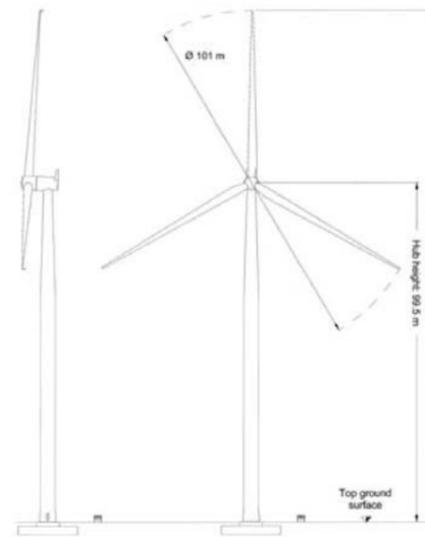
Plan d'élevation d'une machine Siemens SWT-3.0-113, modèle utilisé pour le parc existant
